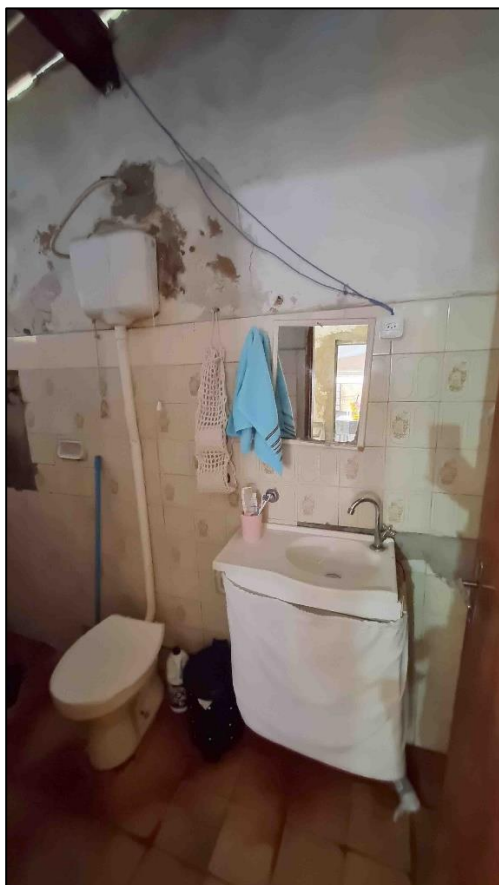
Banheiro social com aplicação parcial de revestimento cerâmico e infiltrações nas paredes.
